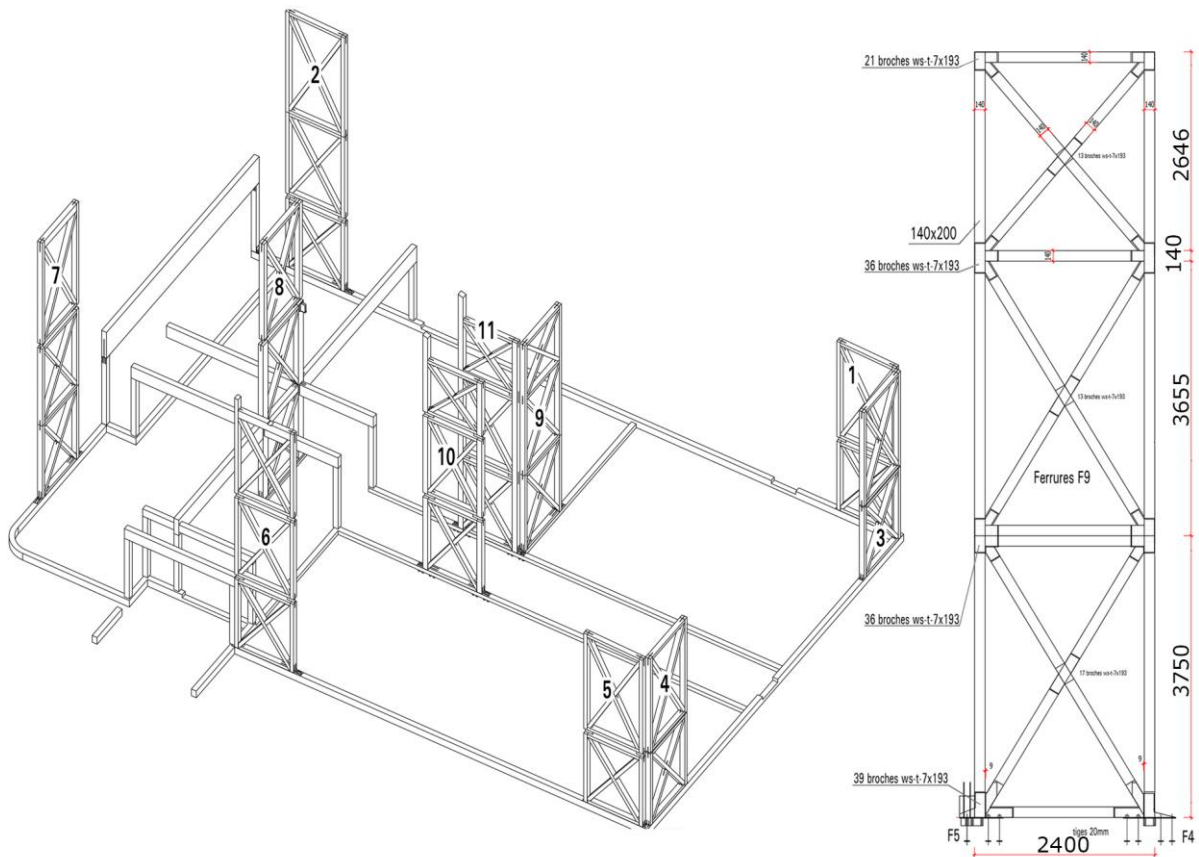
Position des croix de contreventement – document de fabrication des Charpentiers du Haut Beaujolais
